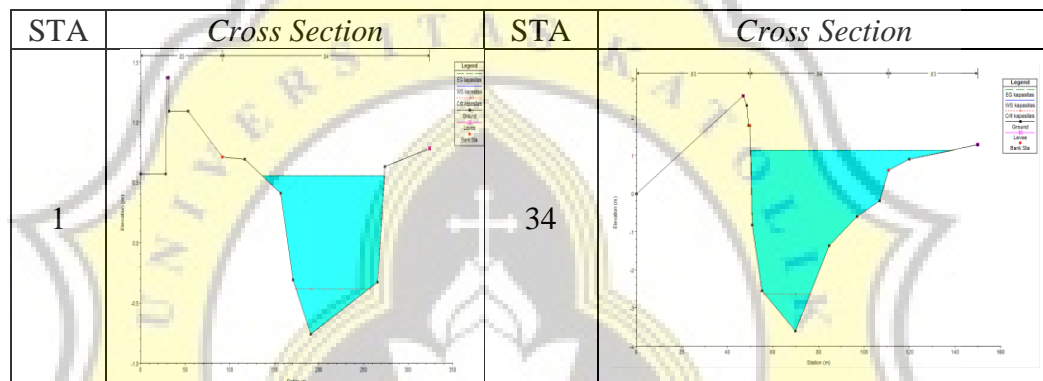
Profil Muka Air Eksisting Terhadap Banjir Debit Rencana 50 Tahun
